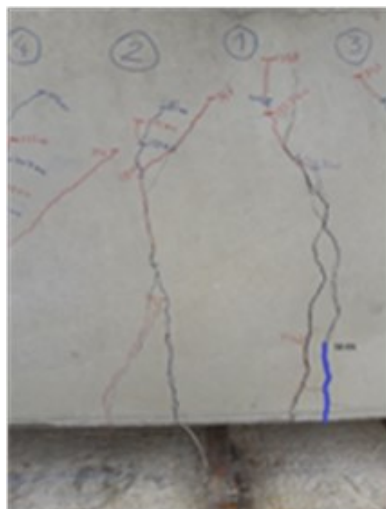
Aparición de la primera fisura para una carga de 58 kN en inspección.
